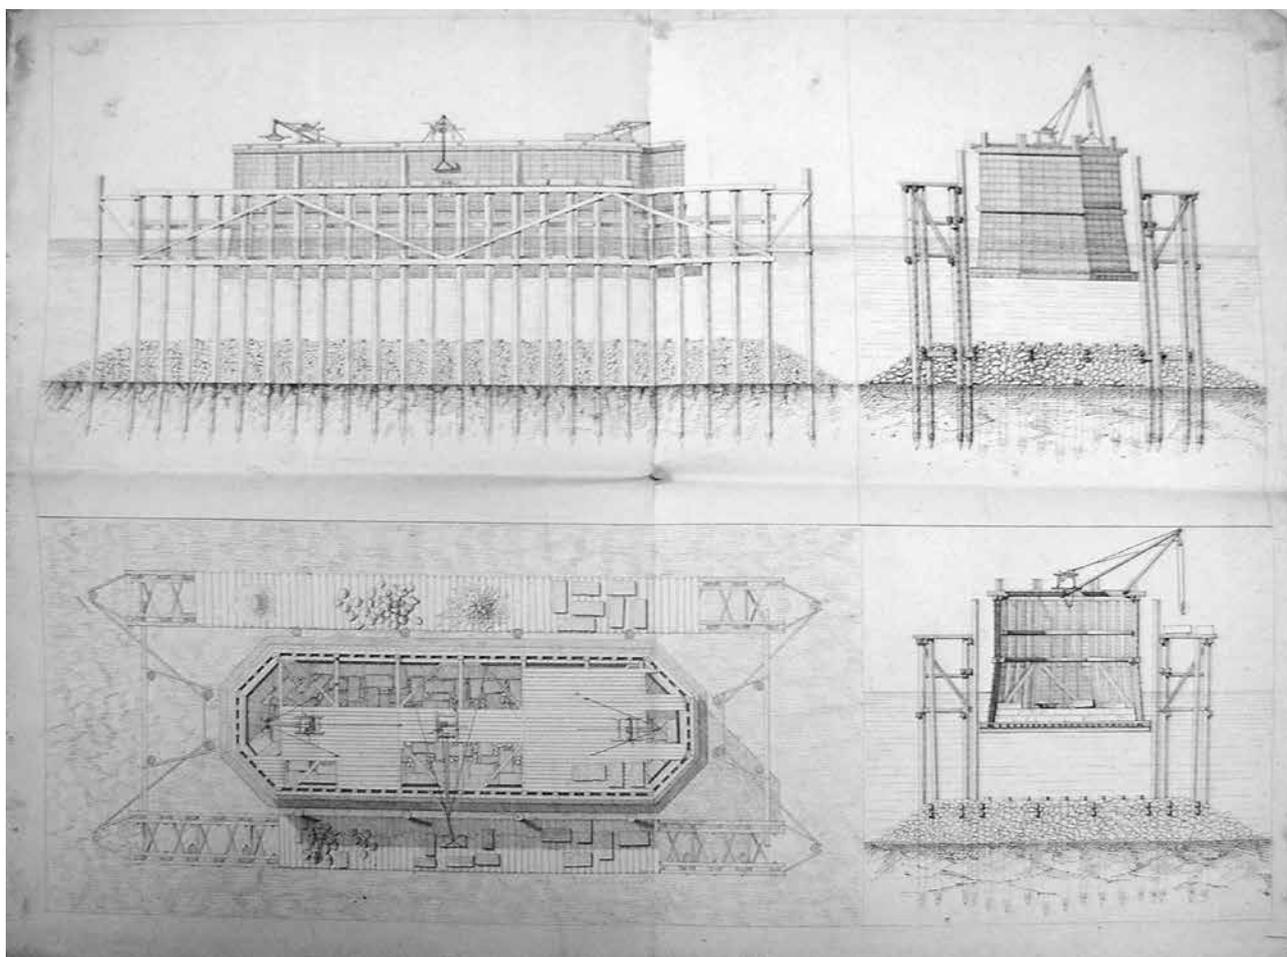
Plan, coupe et élévations des appareils de fondation des piles du pont de pierre, nd, vers 1818 (A.M.Bx., 132 O 1)
